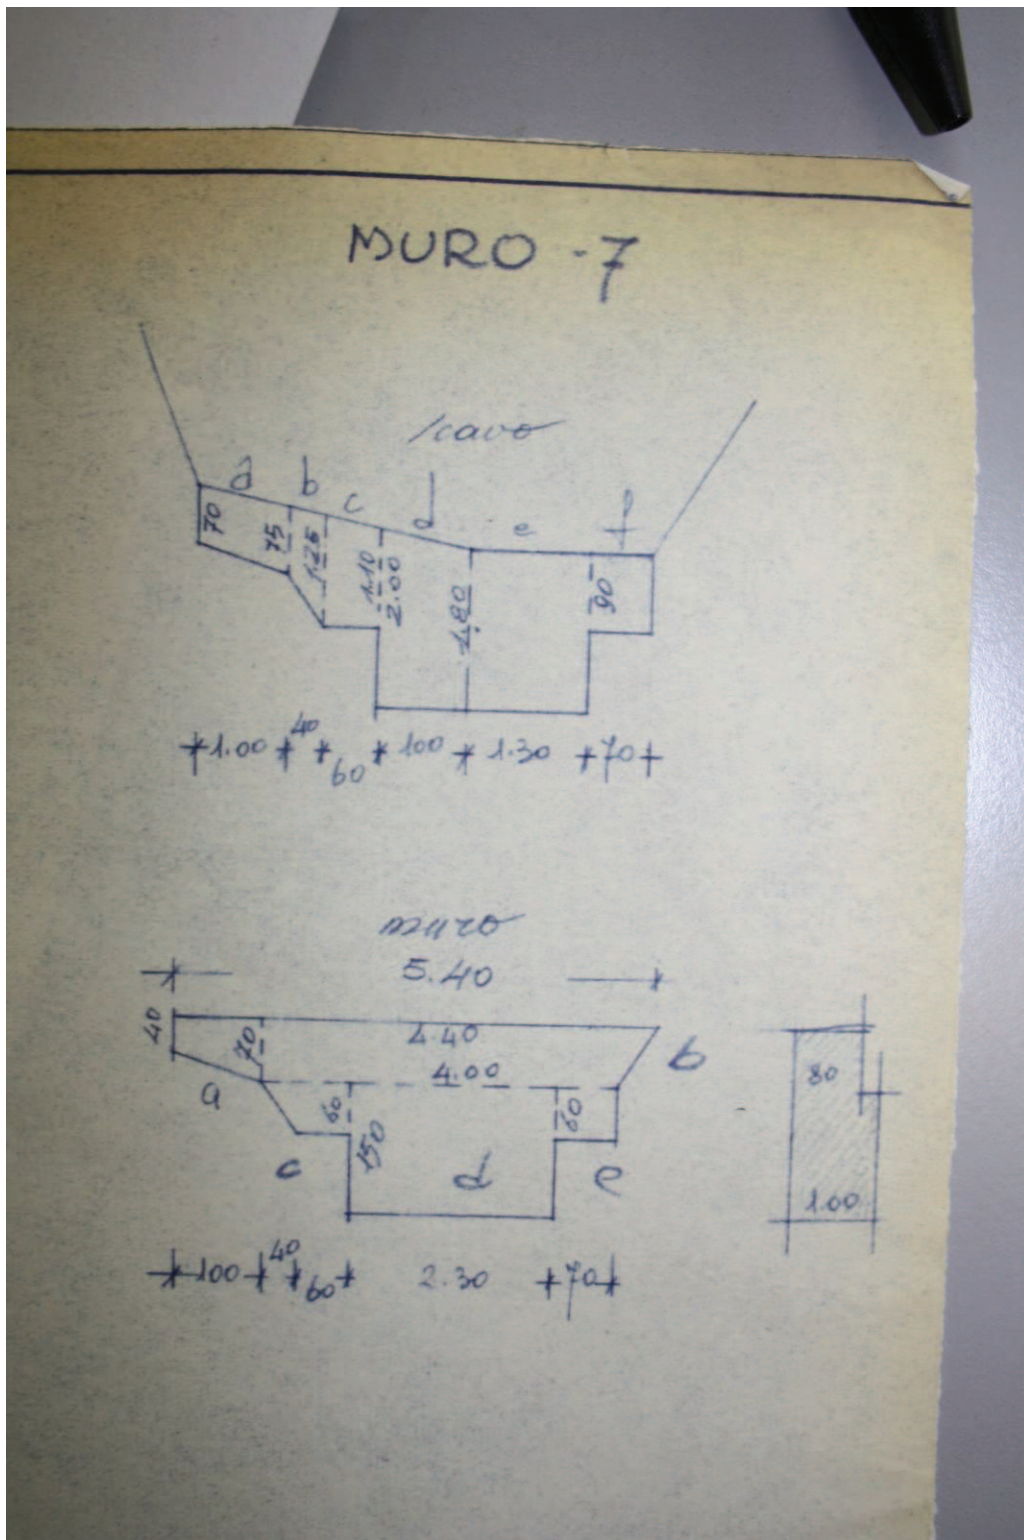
Muro n°7. Archivio CFS Brescia, 2011.
